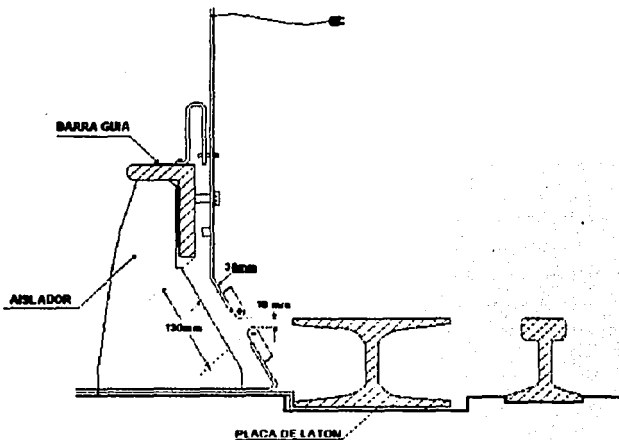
Montaje para prueba al arco eléctrico de un aislador
